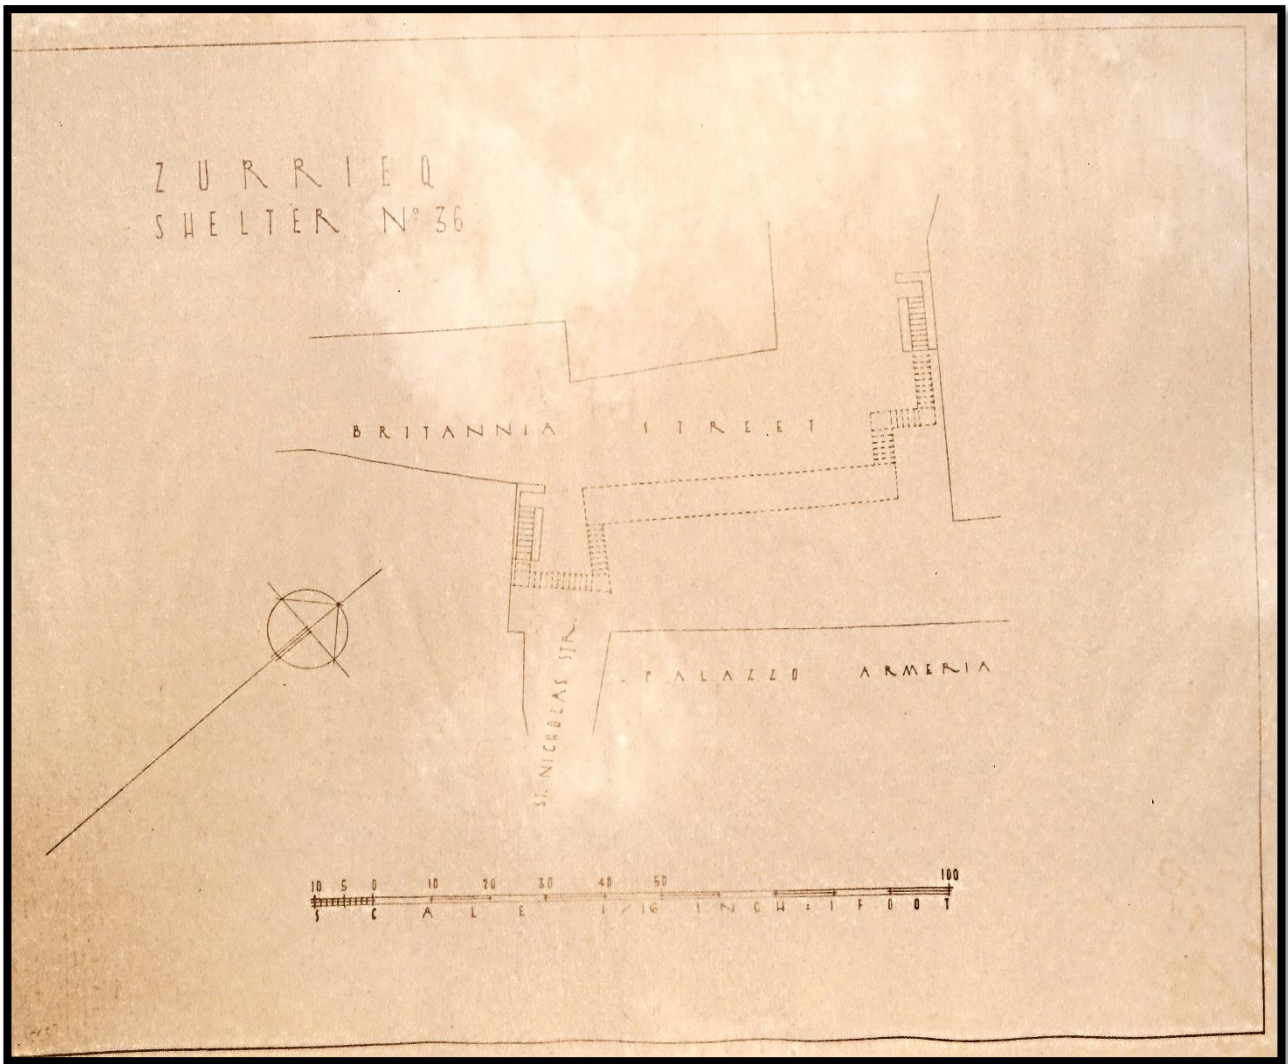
Planta do Abrigo nº36 "Britannia Street*– St. Nicholas Street."
